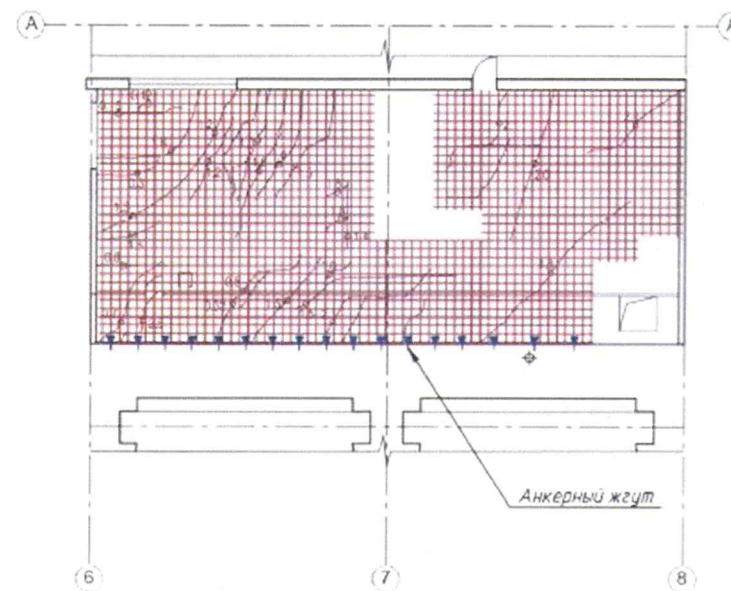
Усиление перекрытия щитового отделения здания ГЭС
